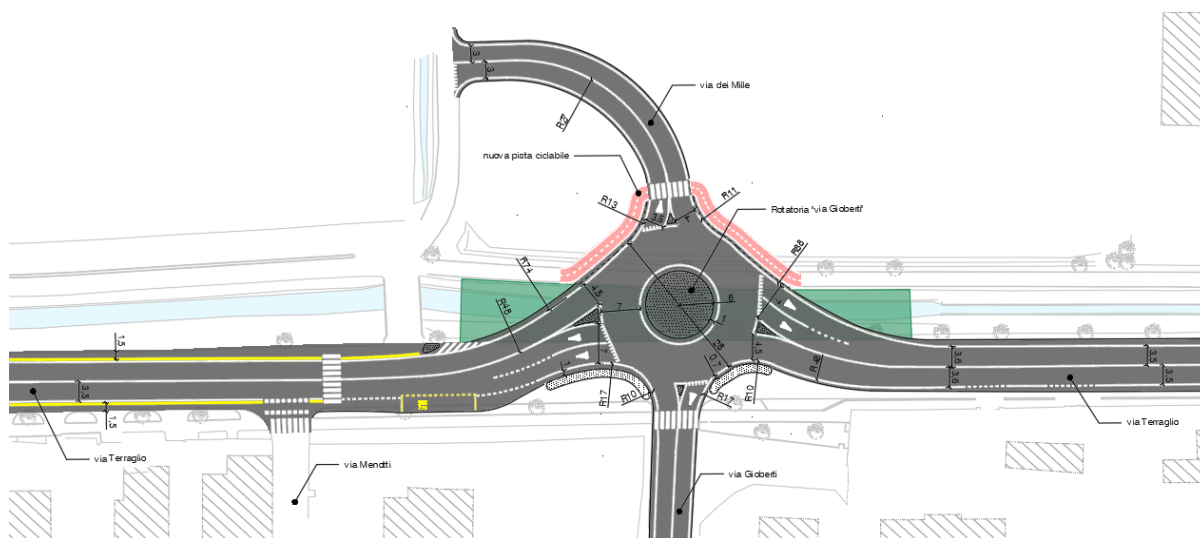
Estratto tavola 2.03 - Stato di progetto: planimetria di progetto 2.0.
